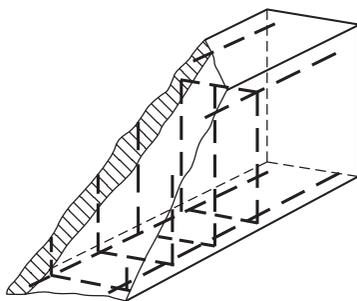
钢筋混凝土纯扭适筋构件的空间扭曲破坏面
